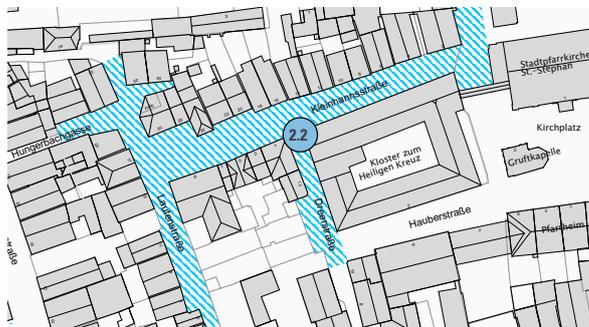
Übersichtslageplan Straßenraumsanierung
